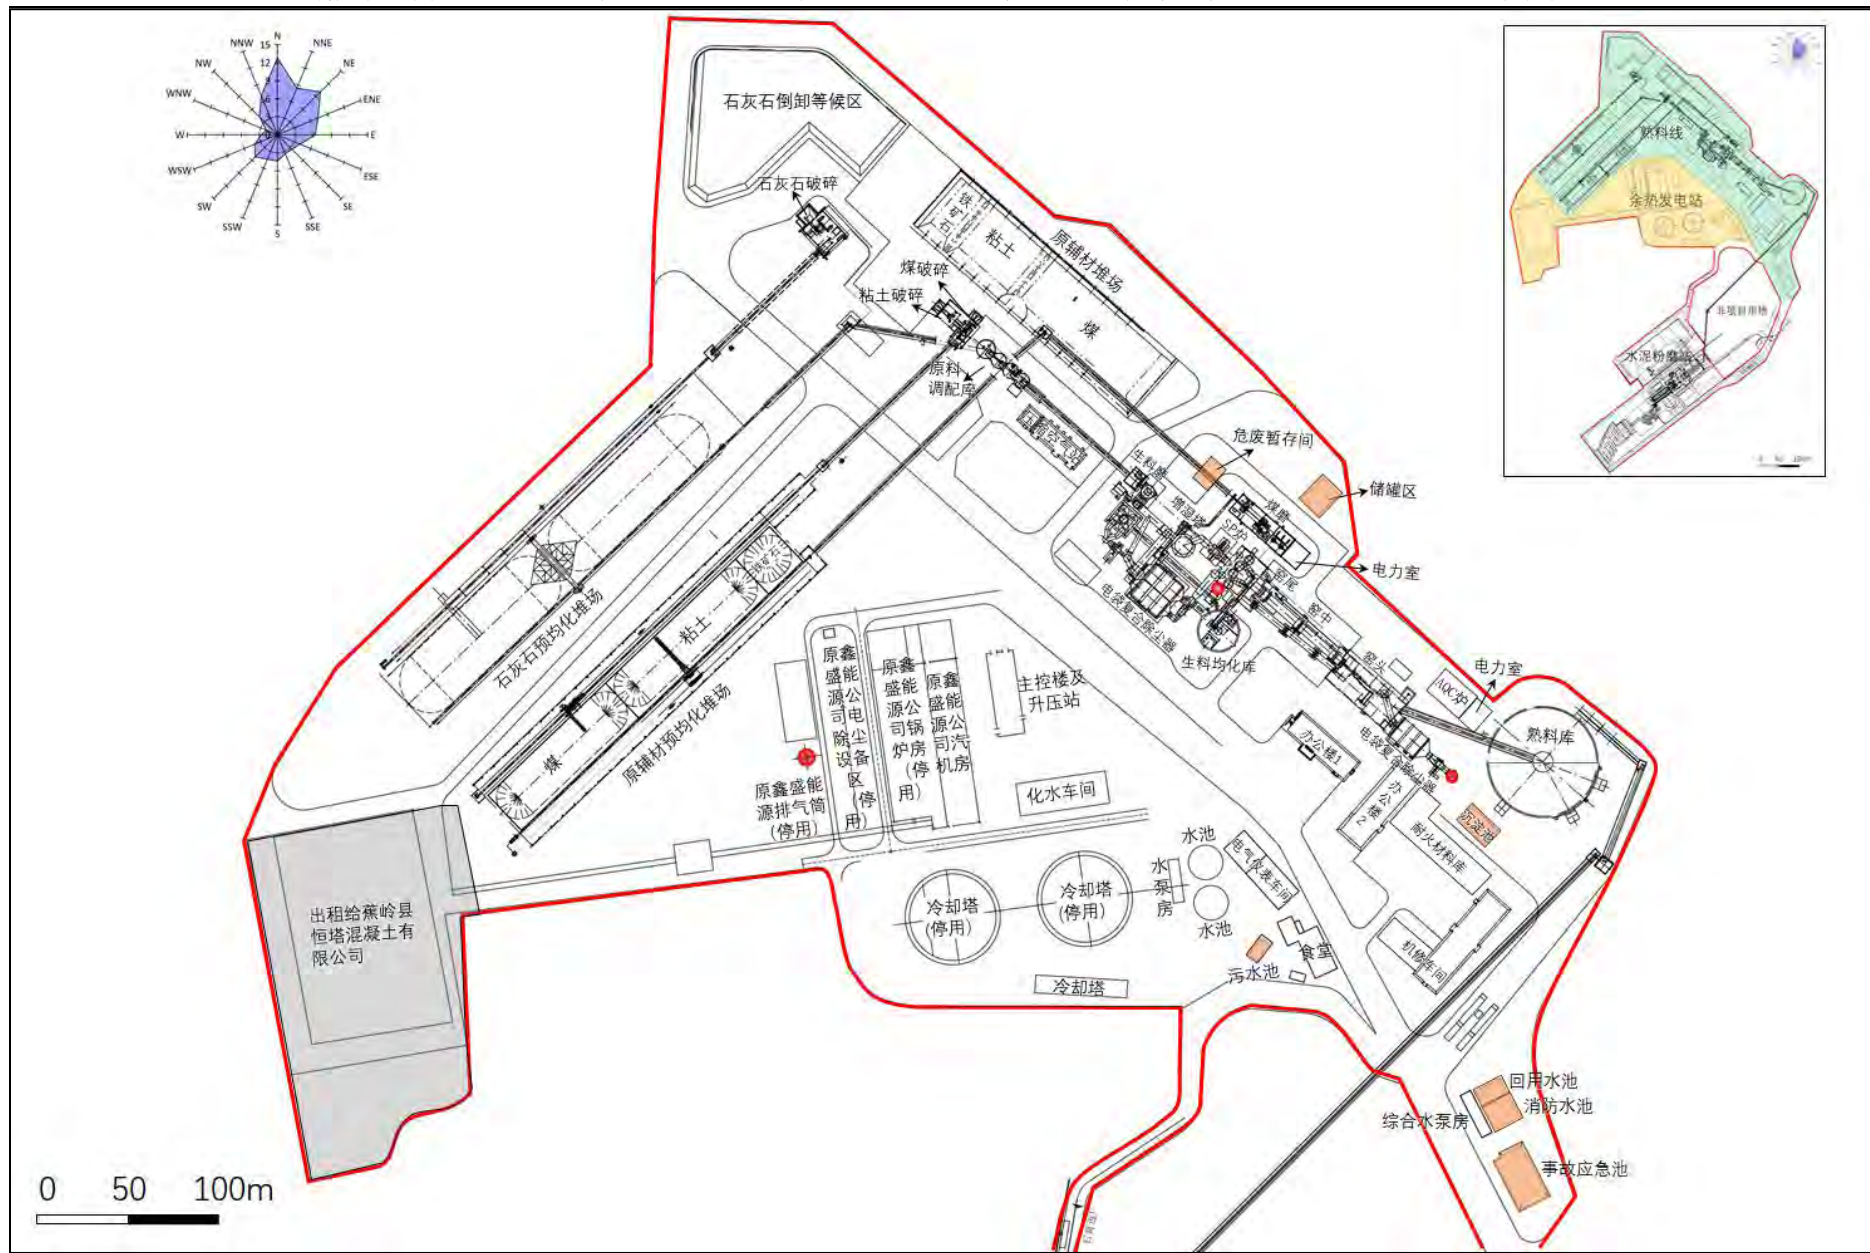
现有项目熟料线和余热发电站平面布置图
